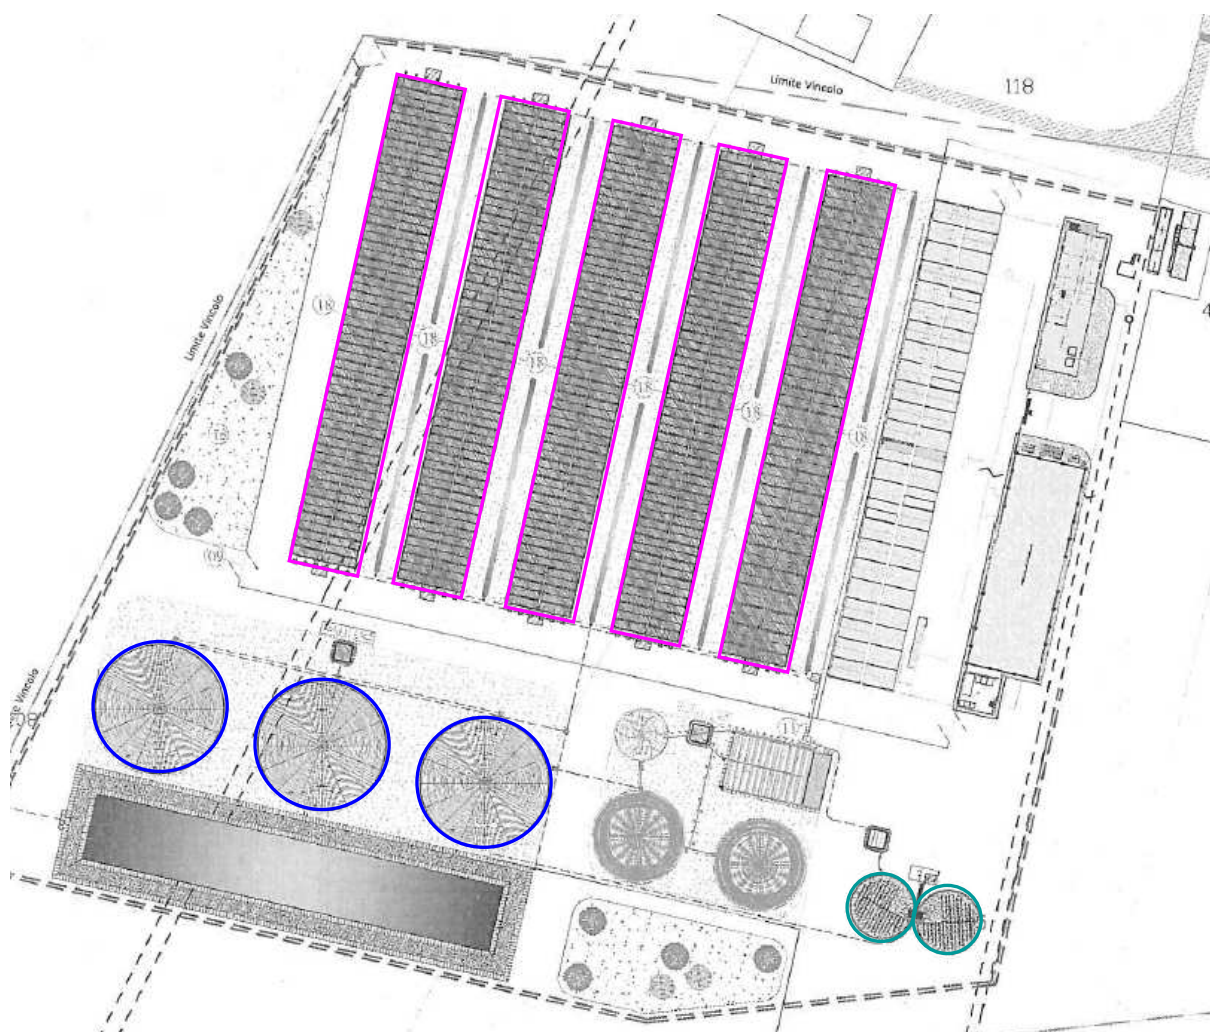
Pianta progettuale con indicazione delle strutture principali dell'impianto
